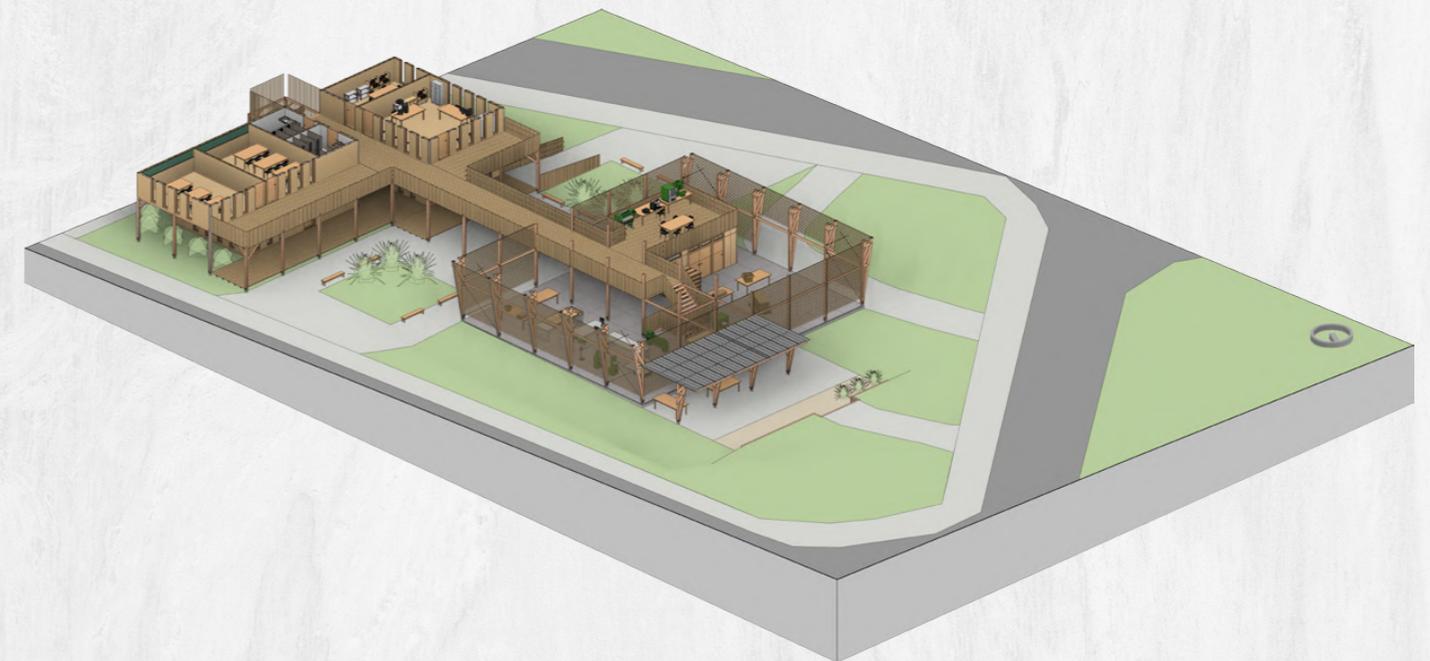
Perspectiva do 2º pavimento das edificações.
